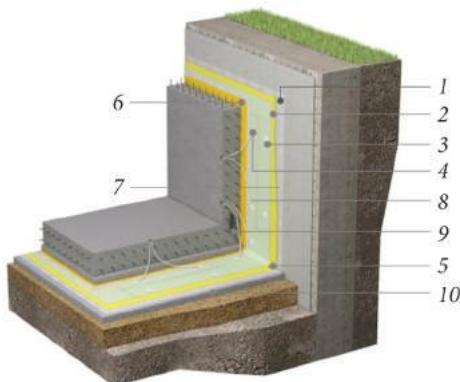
Система ТН-ФУНДАМЕНТ Эксперт Стена в грунте:
